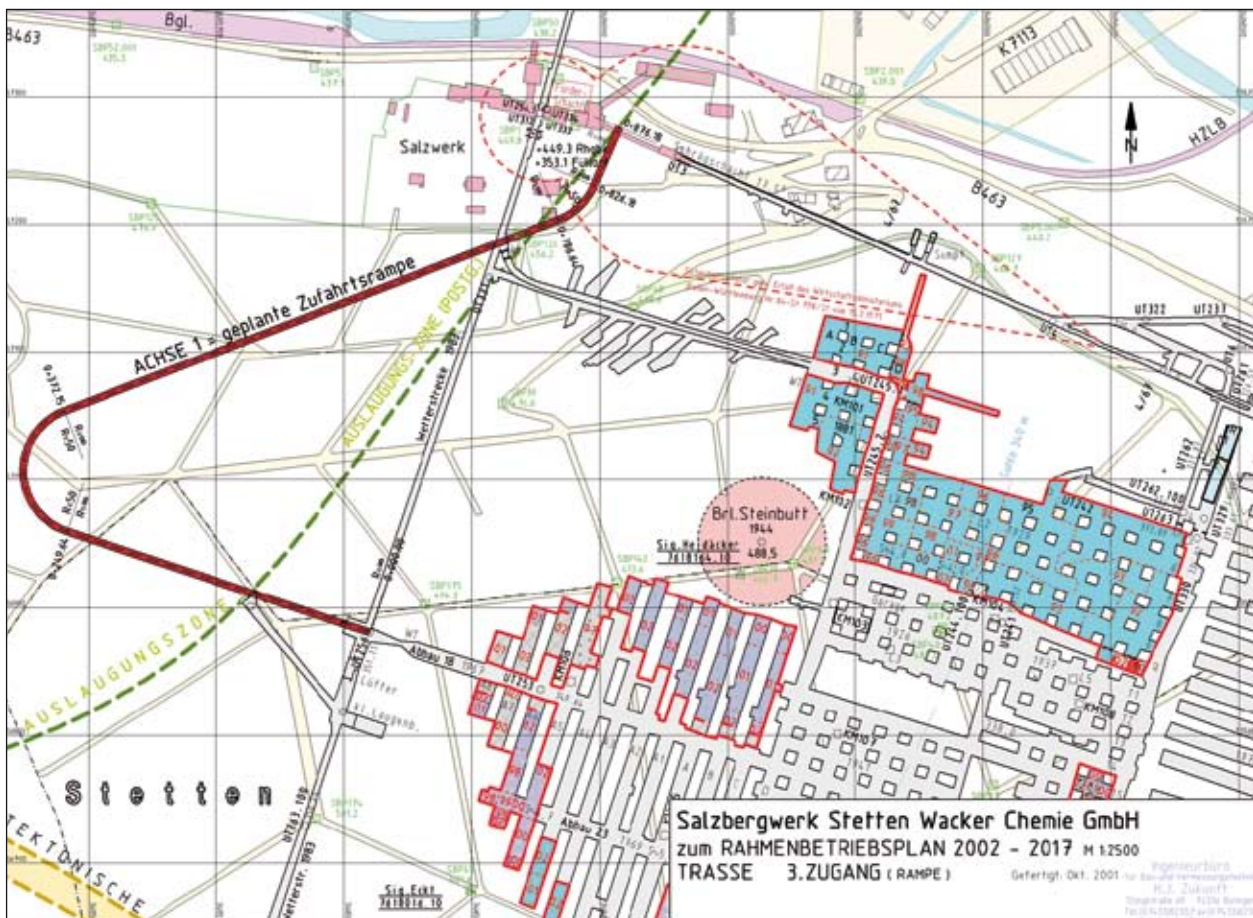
Ausschnitt aus dem Grubenplan des Salzbergwerks Stetten mit Darstellung des alten Abbaubereichs („Schachbrettmuster“) und der neuen Abbaukammern sowie der geplanten Zufahrtsrampe (2006).
